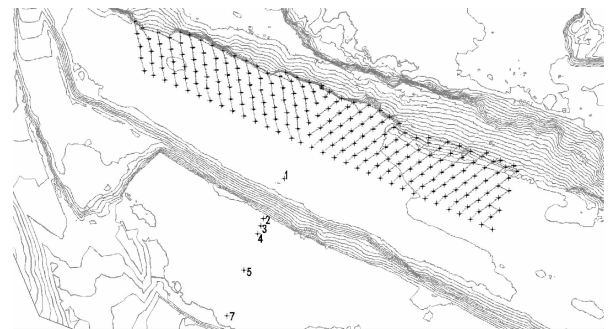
1352 ~ 1340 m 台阶爆破区域测振点布置示意图
